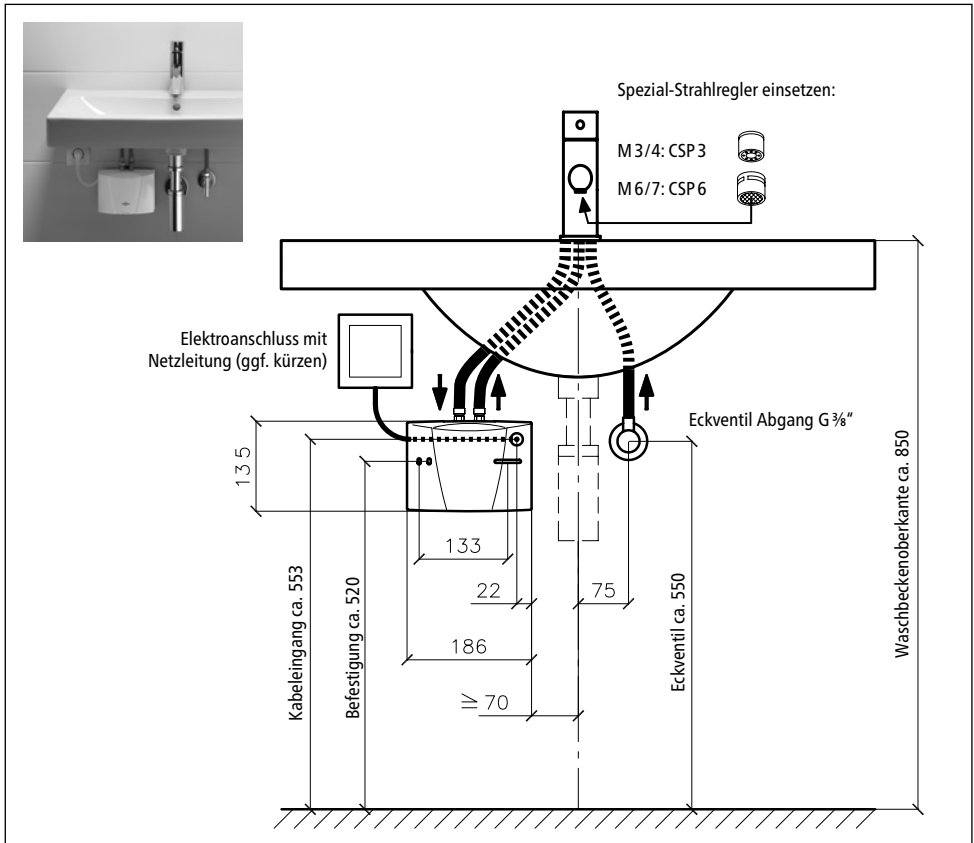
»Drucklose (offene) Installation mit Armatur für drucklose Warmwassergeräte« (Maßangaben in mm)
